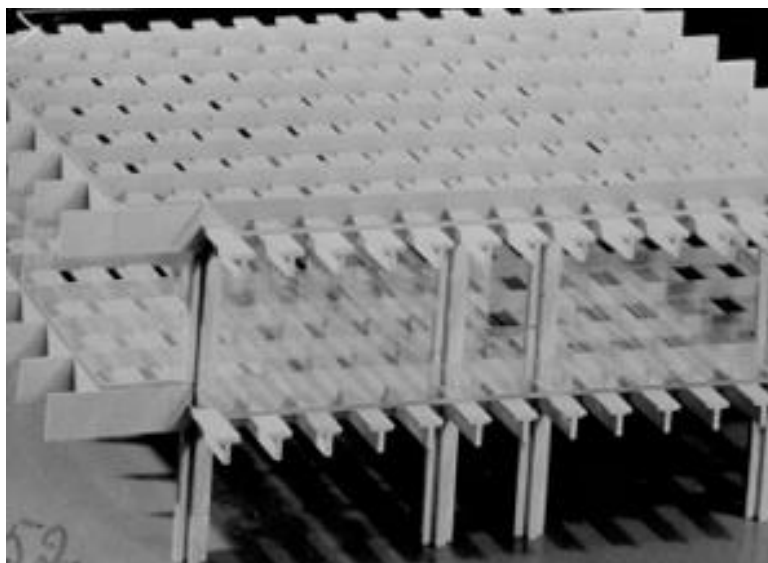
Maquete do sistema construtivo tipo estrado. Fonte: DPP/UFMG, 1969.
